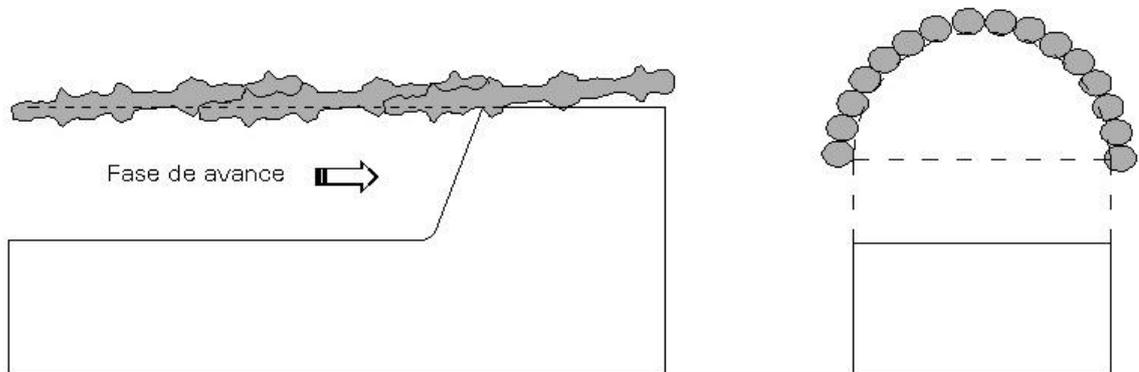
Perfil longitudinal y sección transversal de paraguas con columnas de jet grouting
